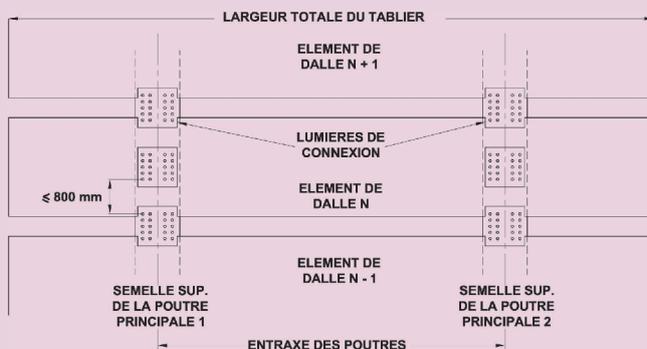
Disposition par groupes des connecteurs dans le cas d'une dalle préfabriquée par éléments de pleine largeur
